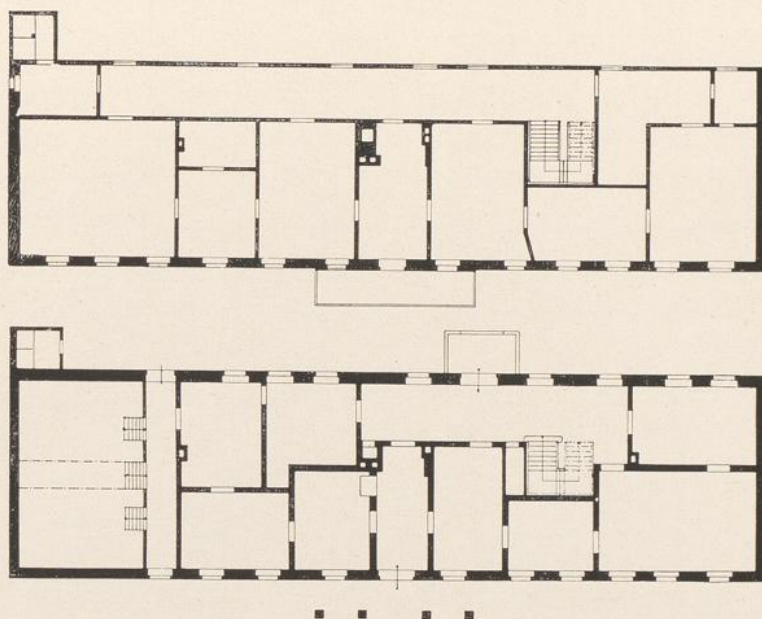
Steinkirchen. Obergeschoß. Erdgeschoß
